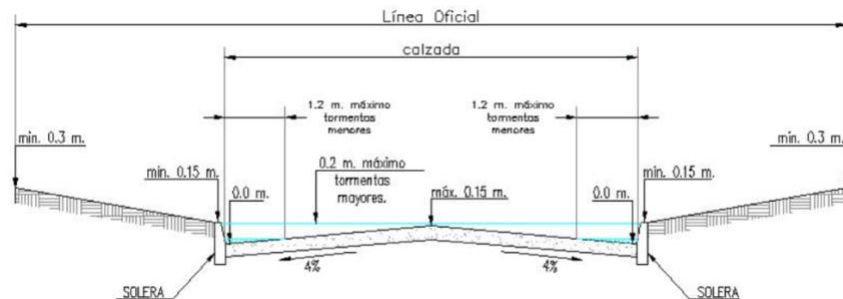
Ejemplo de sección transversal alternativa en vías locales y de servicio con coronamiento al centro y cuneta a ambos lados de la calzada [10].
